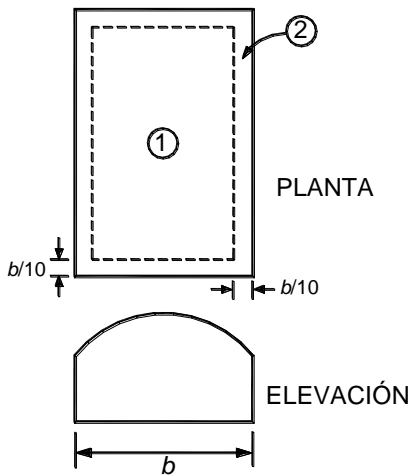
Elementos de recubrimiento en cubiertas en arco
